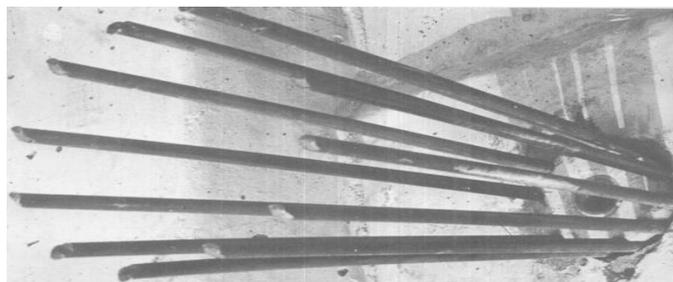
Vista del anclaje del sistema Freyssinet.
